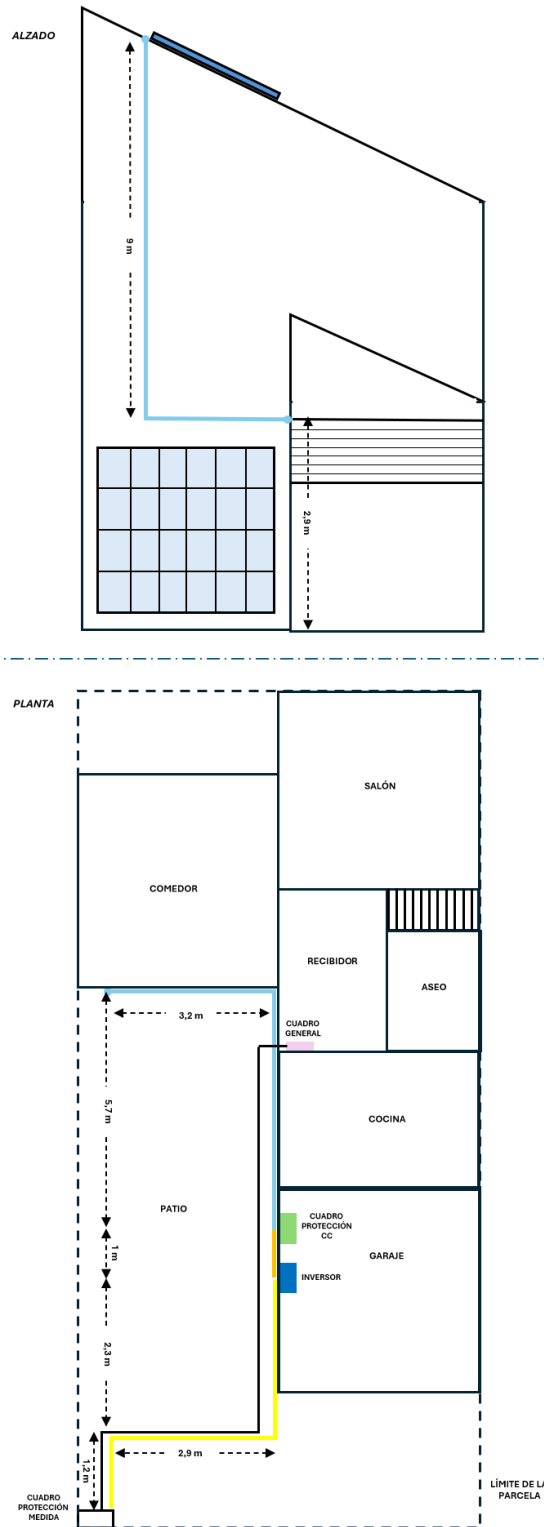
Alzado y planta de la vivienda con longitudes del cableado. Elaboración propia.
